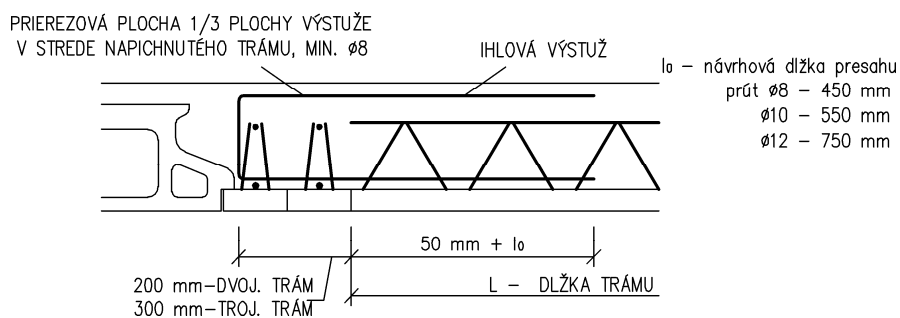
Detail uloženia na prievlak (Rez C-C)
